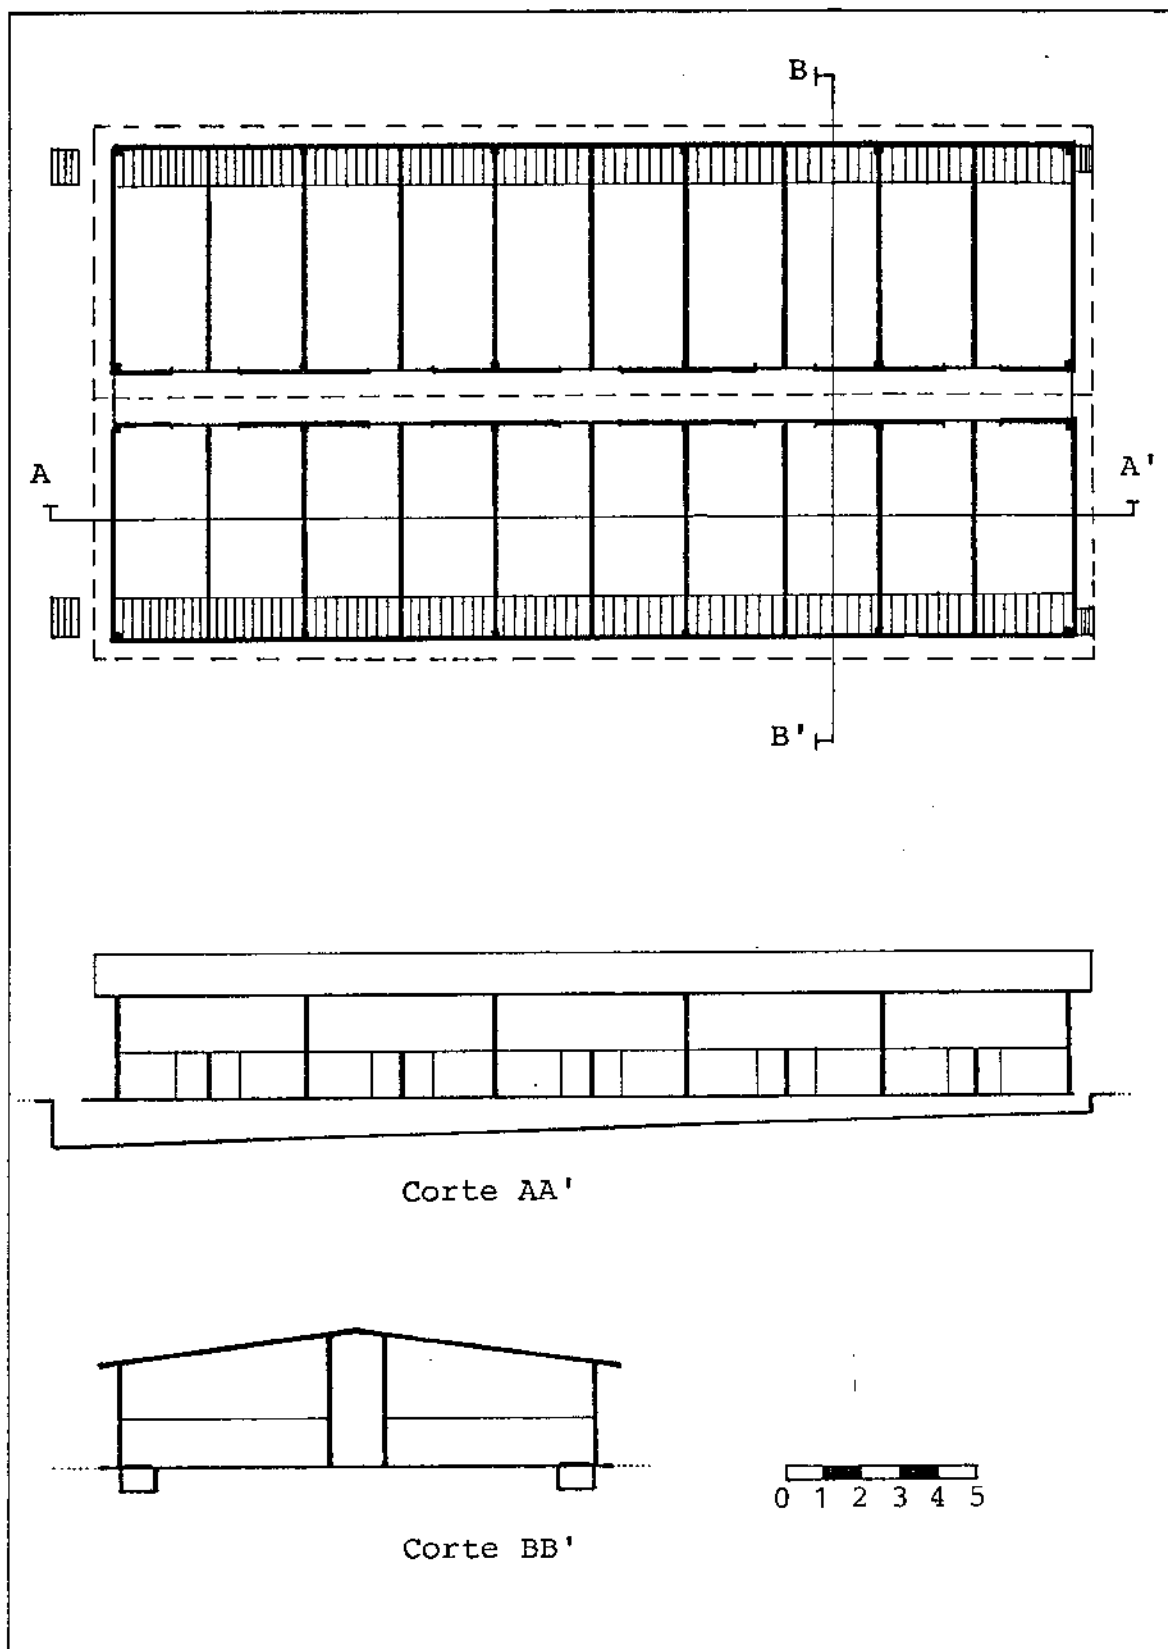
Planta baixa e cortes longitudinal e vertical da edificação estudada.
